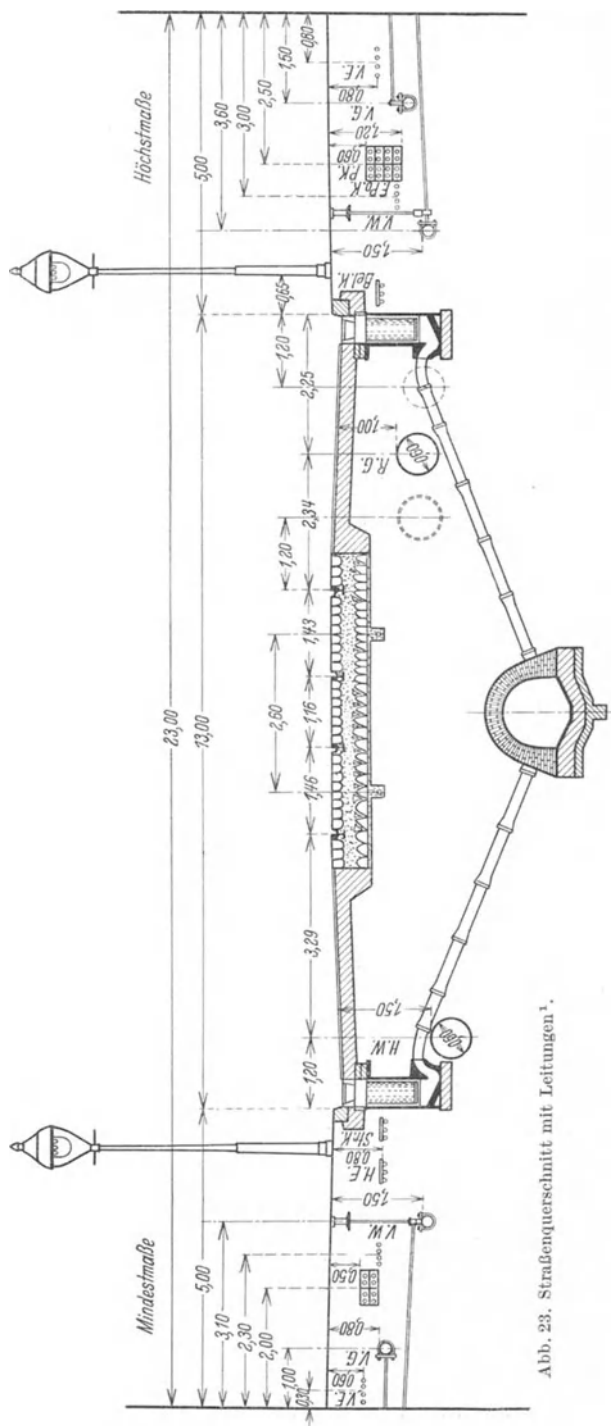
Straßenquerschnitt mit Leitungen¹.
